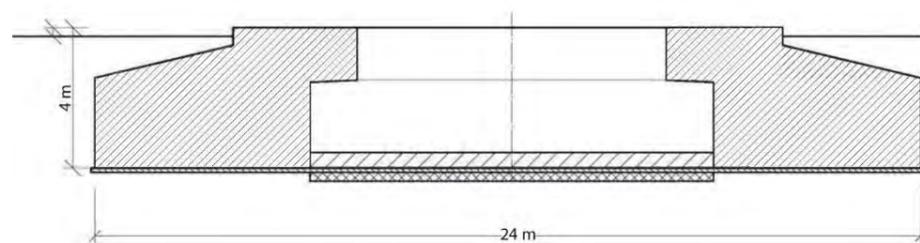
Schéma d'une fondation d'éolienne (source : wpd, 2018)
